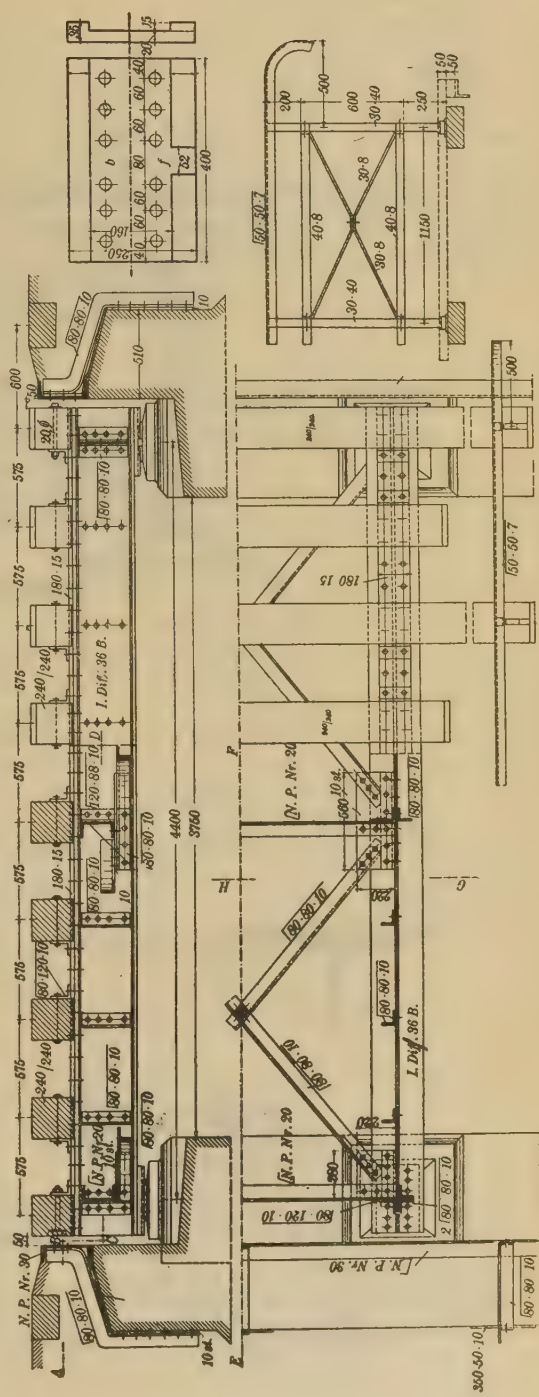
Puente con traviesas sobre cuchillos. Estructura completa.
